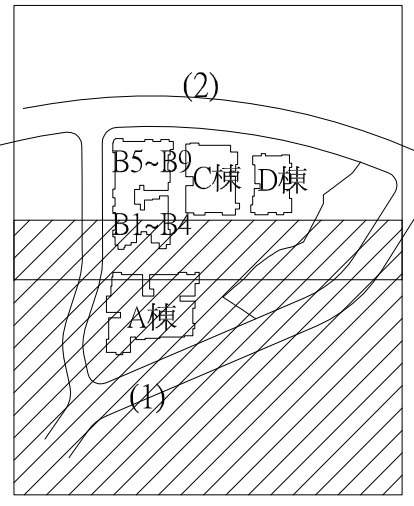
A棟地下壹層 B1~B4.壹層 B5~B9.貳層 C棟地下貳層D棟地下參層平面圖 Scale 1/500 (EL+84.6)
